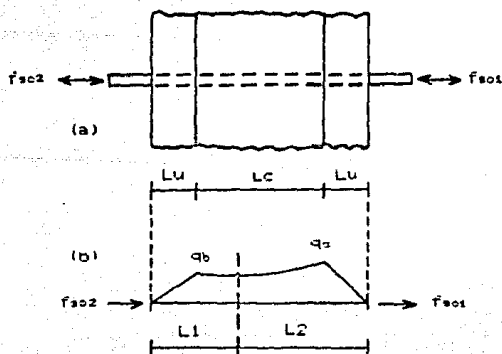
(a) Barra de refuerzo anclada en la junta interior viga-columna de concreto.
